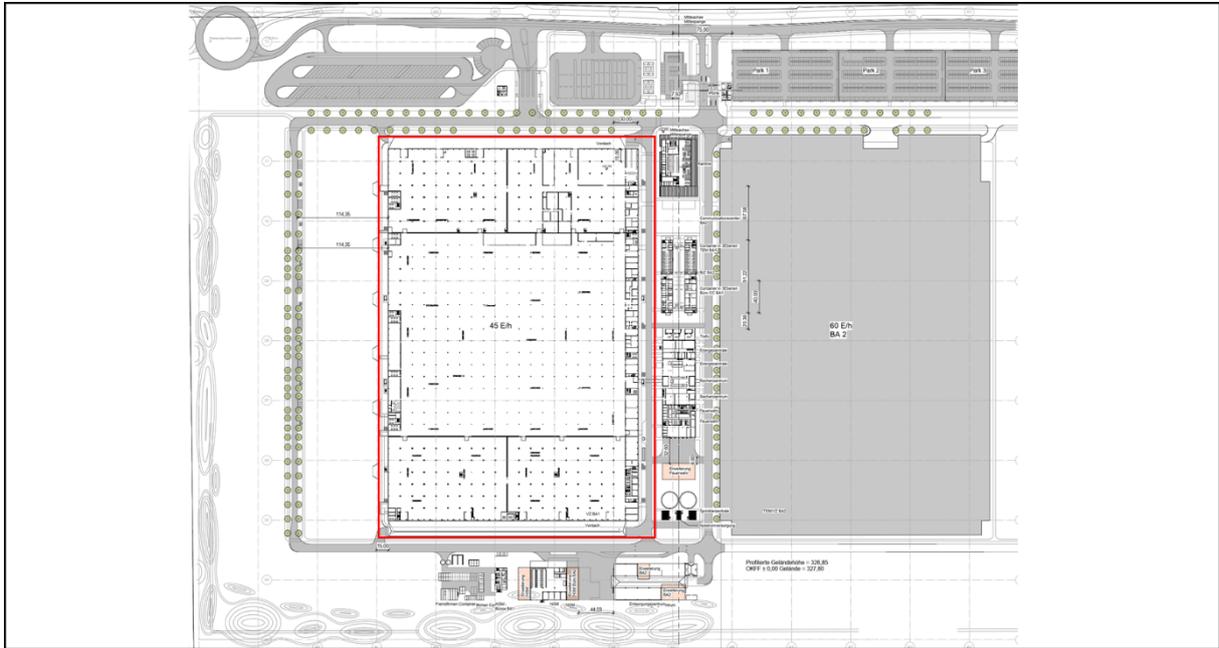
Produktions- und Logistikgebäude - Lageplan Dachaufsicht.
